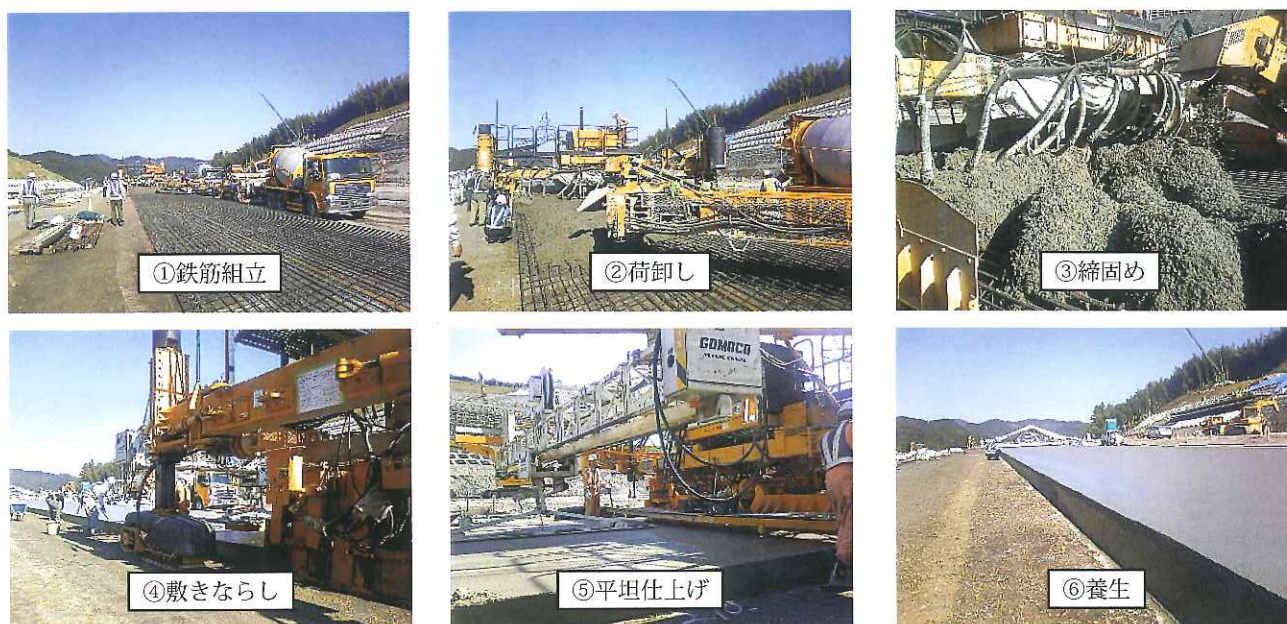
スリップフォーム工法による連続鉄筋コンクリート舗装の舗設
